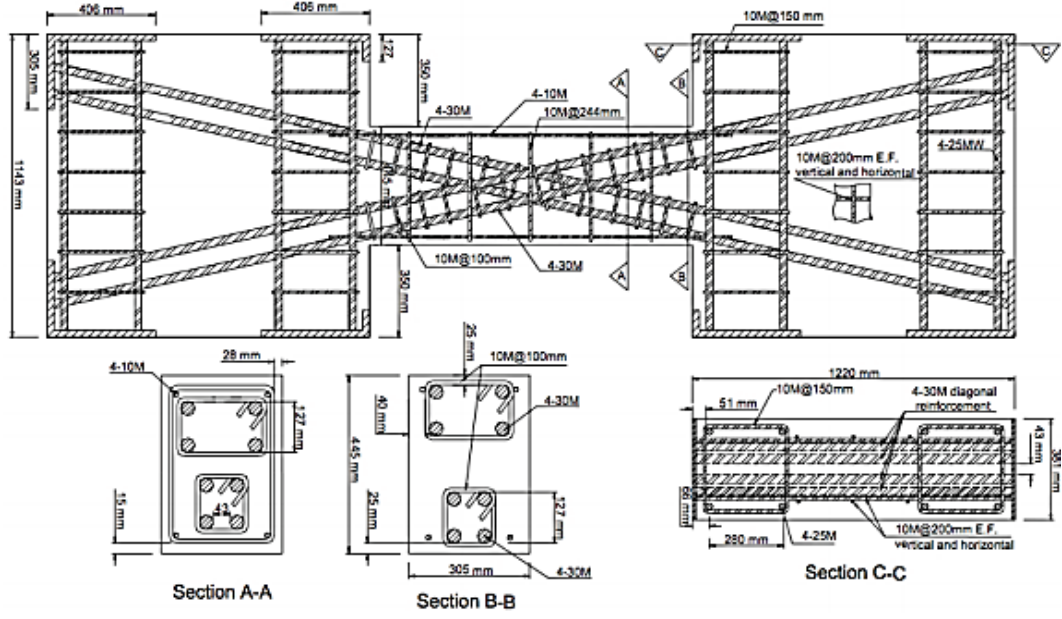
Barney ve ark. ait bağ kirişi donatı detayı [102]
